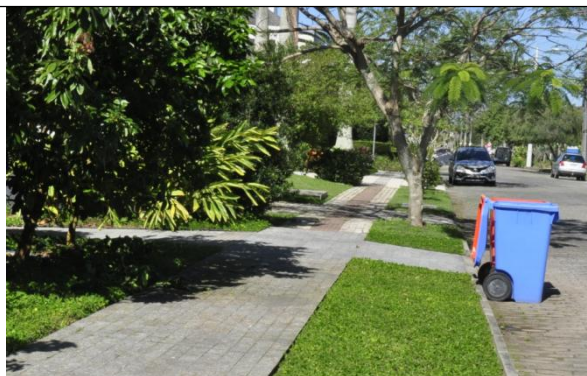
Rua dos Uararás - vegetação sobre passeio.
